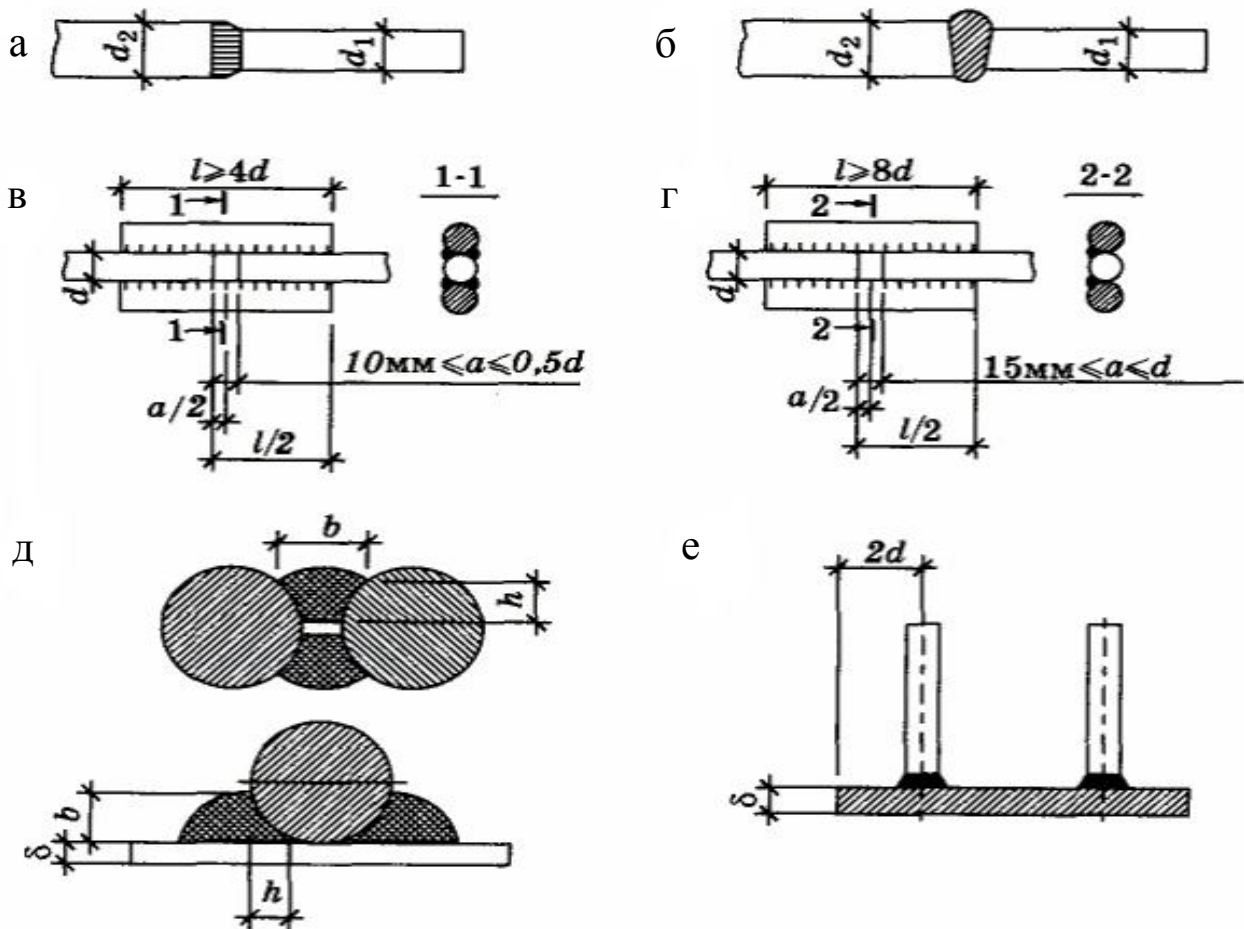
Зварні з'єднання арматури: а – контактне електрозварювання встик; б – дугове ванне зварювання в інвентарній формі; в – дугове зварювання з накладками із чотирма фланговими швами; г – те саме, з двома фланговими швами; д – позначення розмірів зварного шва; е – зварне з'єднання в тавр стрижнів з пластиною
